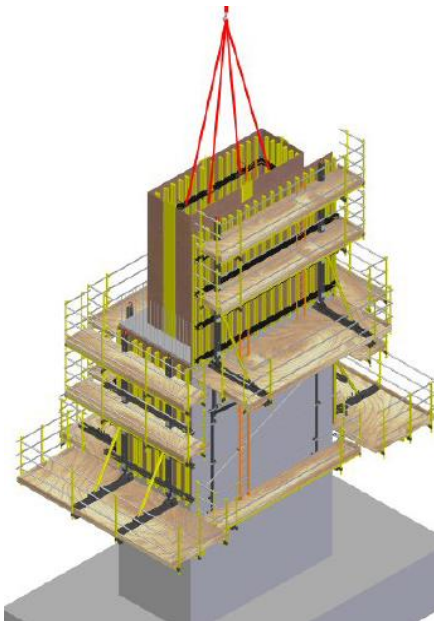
aj. Izado de encofrado interior y colocación en el siguiente nivel. Recuperado de: Ulma Construction, *Instrucción técnica de montaje*.
